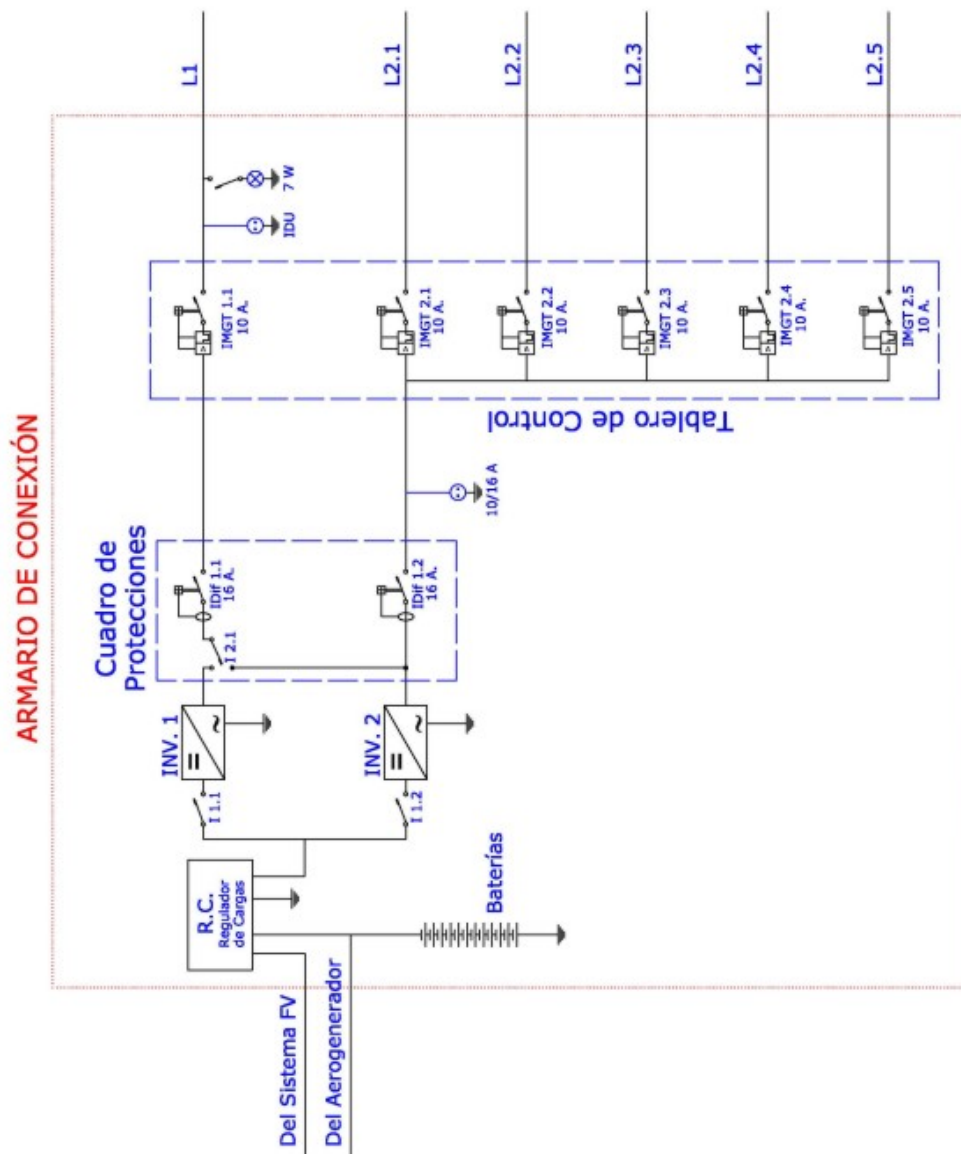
Detalle de la instalación del “Armario de conexión”.
